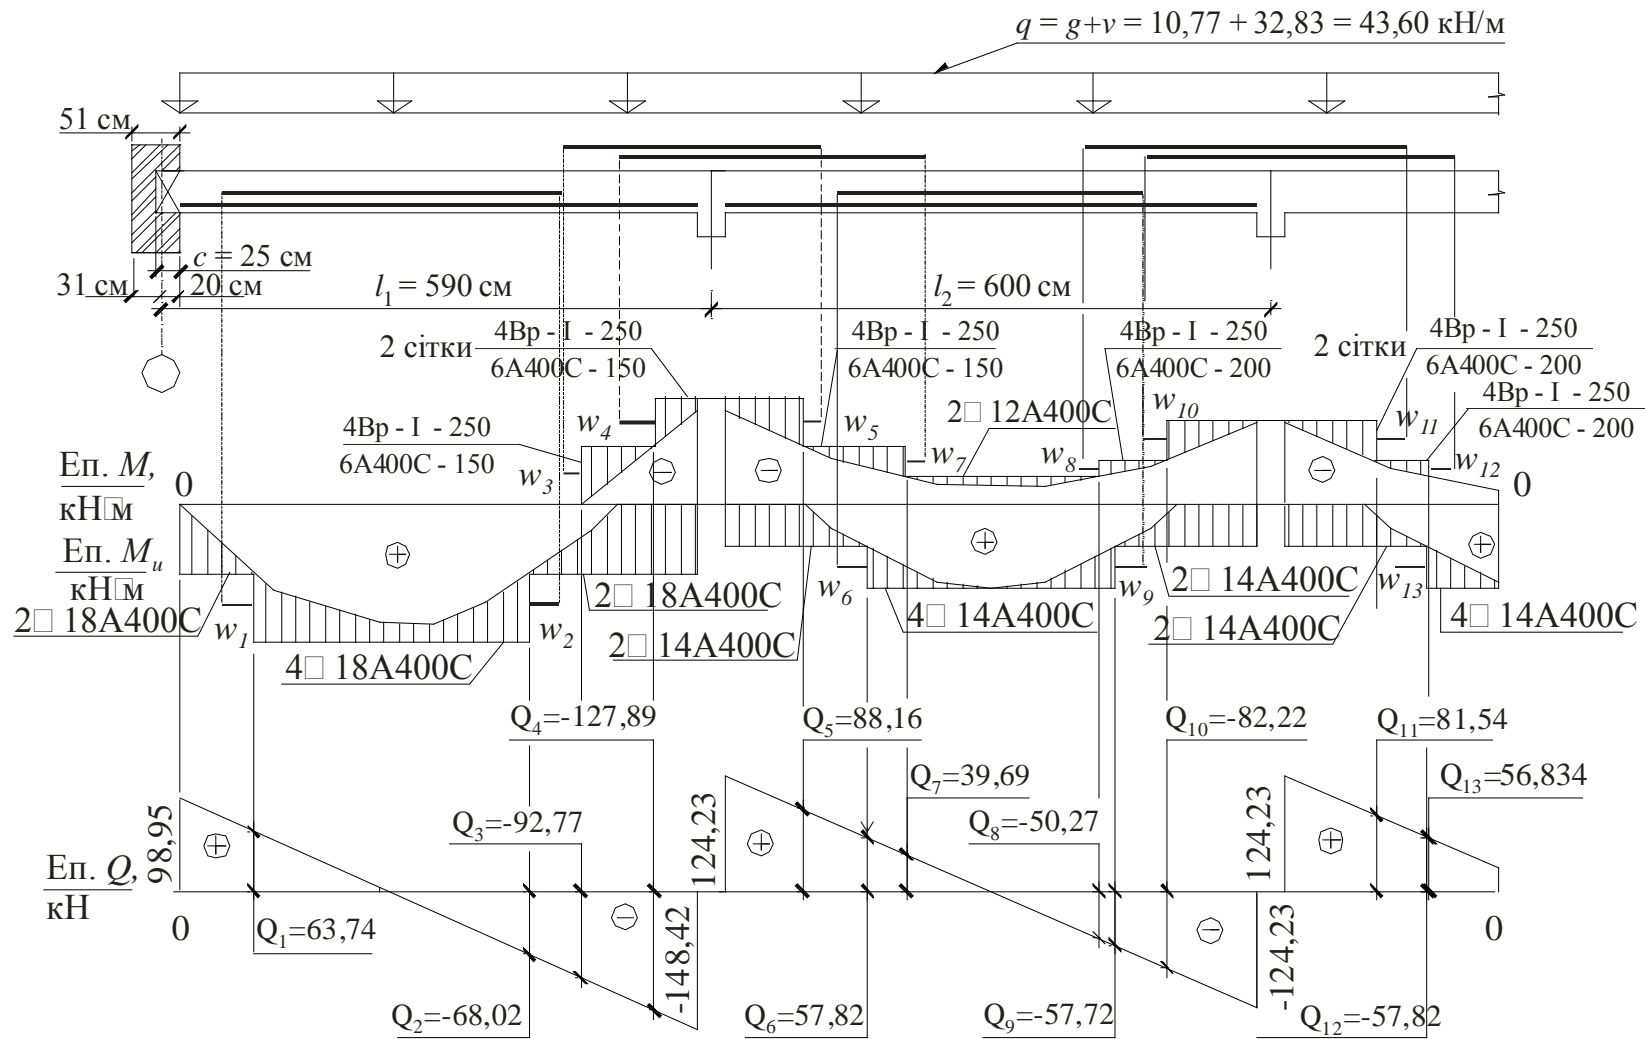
Побудова епюри моментів M , епюри матеріалів M_u та епюри поперечних сил Q другорядної балки
